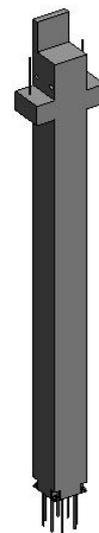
Elemento Pilastro prefabbricato (modello Revit).
